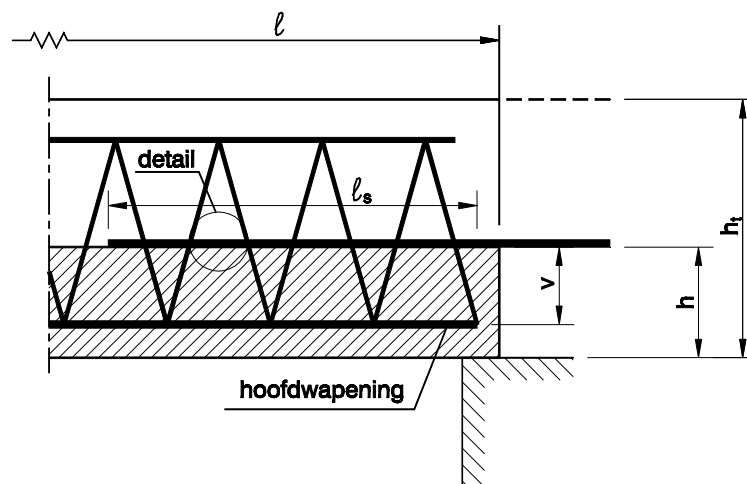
a - Verankering van de hoofdwapening met uitstekende wapening ter plaatse van een oplegging
